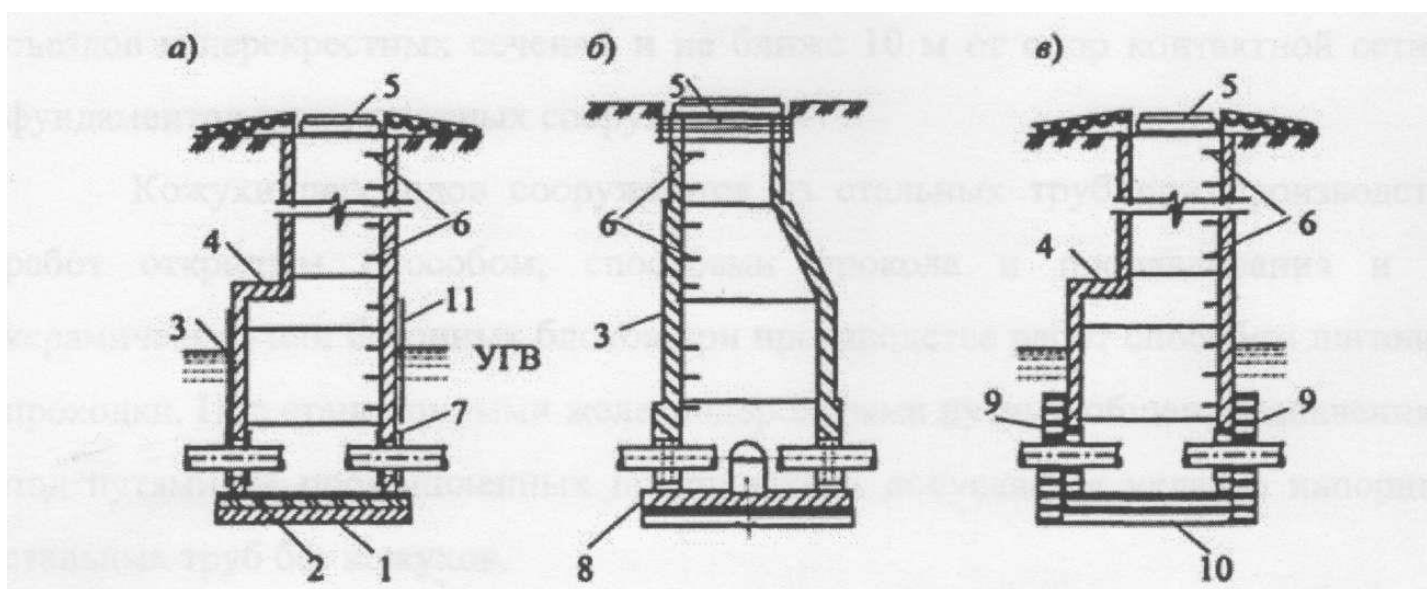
Сборный круглый {а, б) и прямоугольный (в) железобетонные колодцы, устраиваемые в грунтах:
